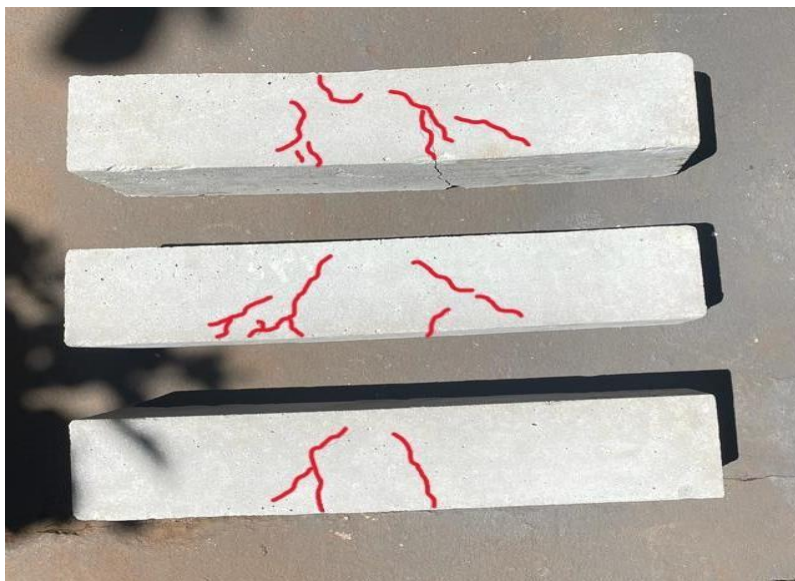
Viga com armaduras de aço (Fonte: Autor, 2023)
